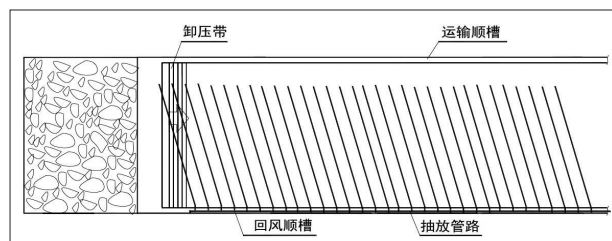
本煤层钻孔抽放瓦斯方法钻孔布置平面示意图
